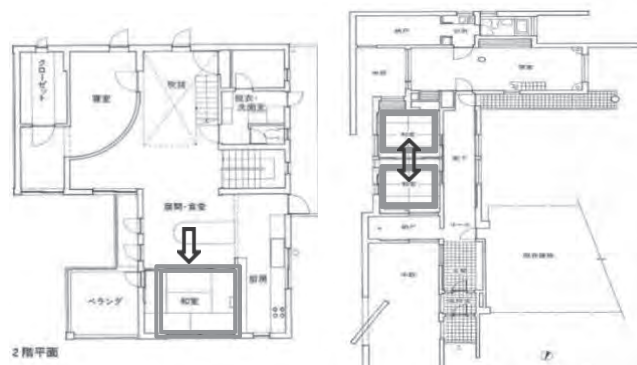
左 : b 型平面図 右 : h 型 平面図 (『住宅特集』1986 年 2 月号より)
